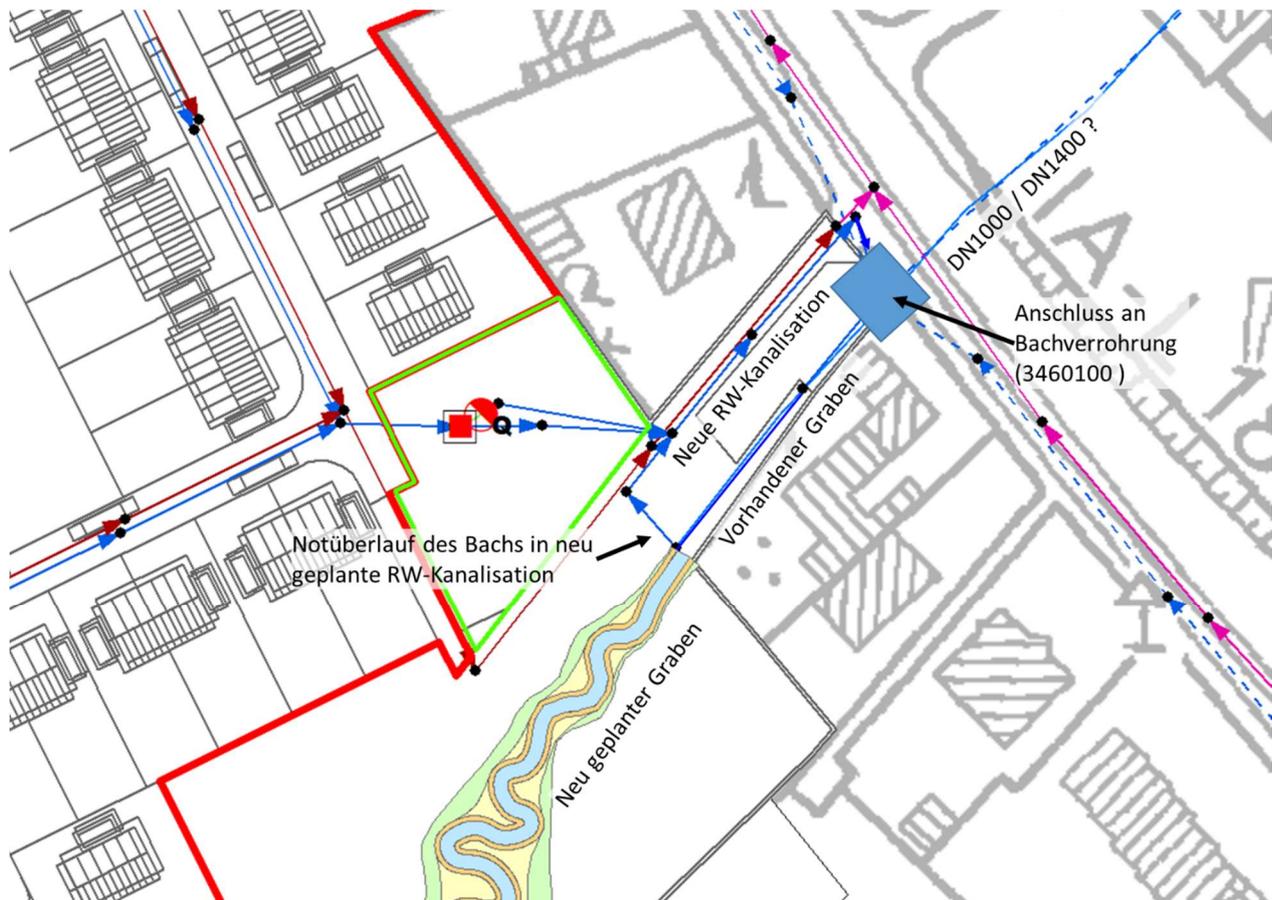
Variante 3: Anschluss an die vorhandene Bachverrohrung (an Absturzbauwerk 3460100), Notüberlauf Mühlenbach in geplante Kanalisation
